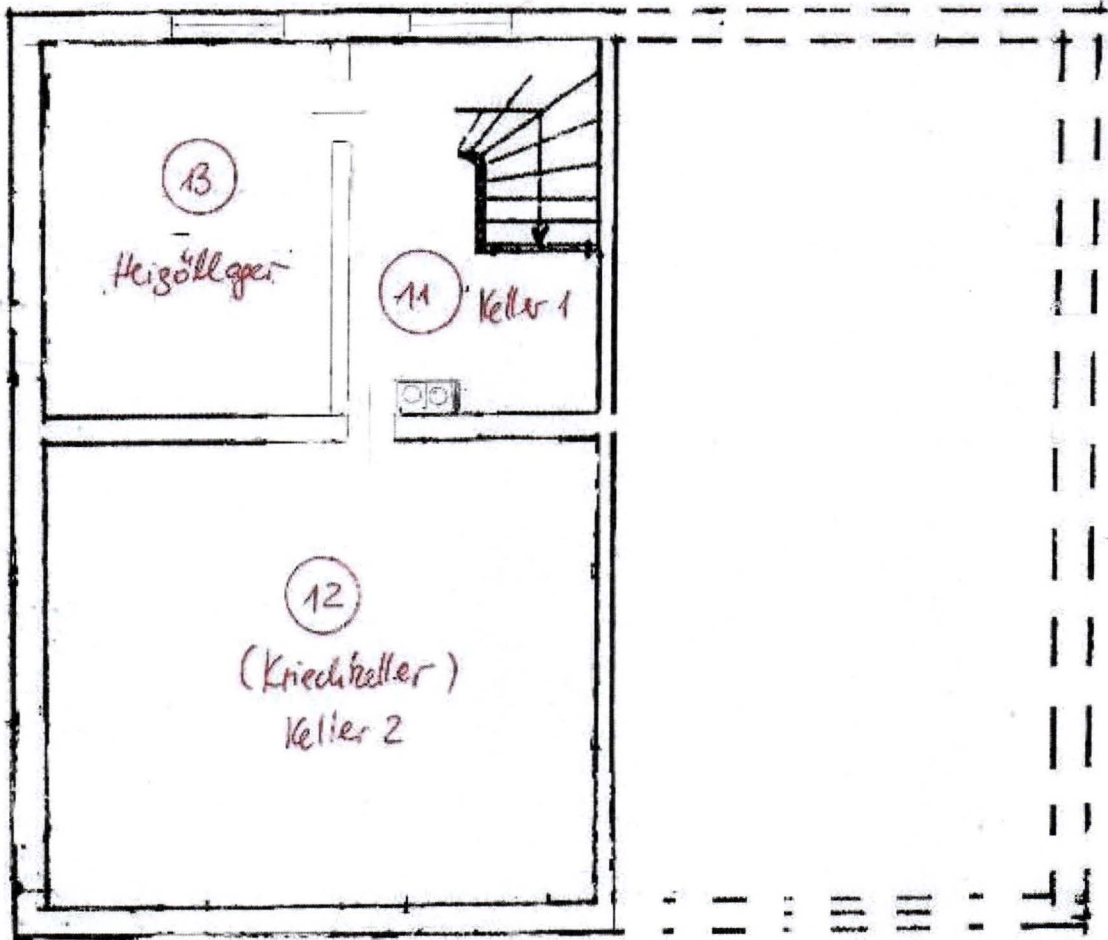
Wohnhaus, Grundriss KG
